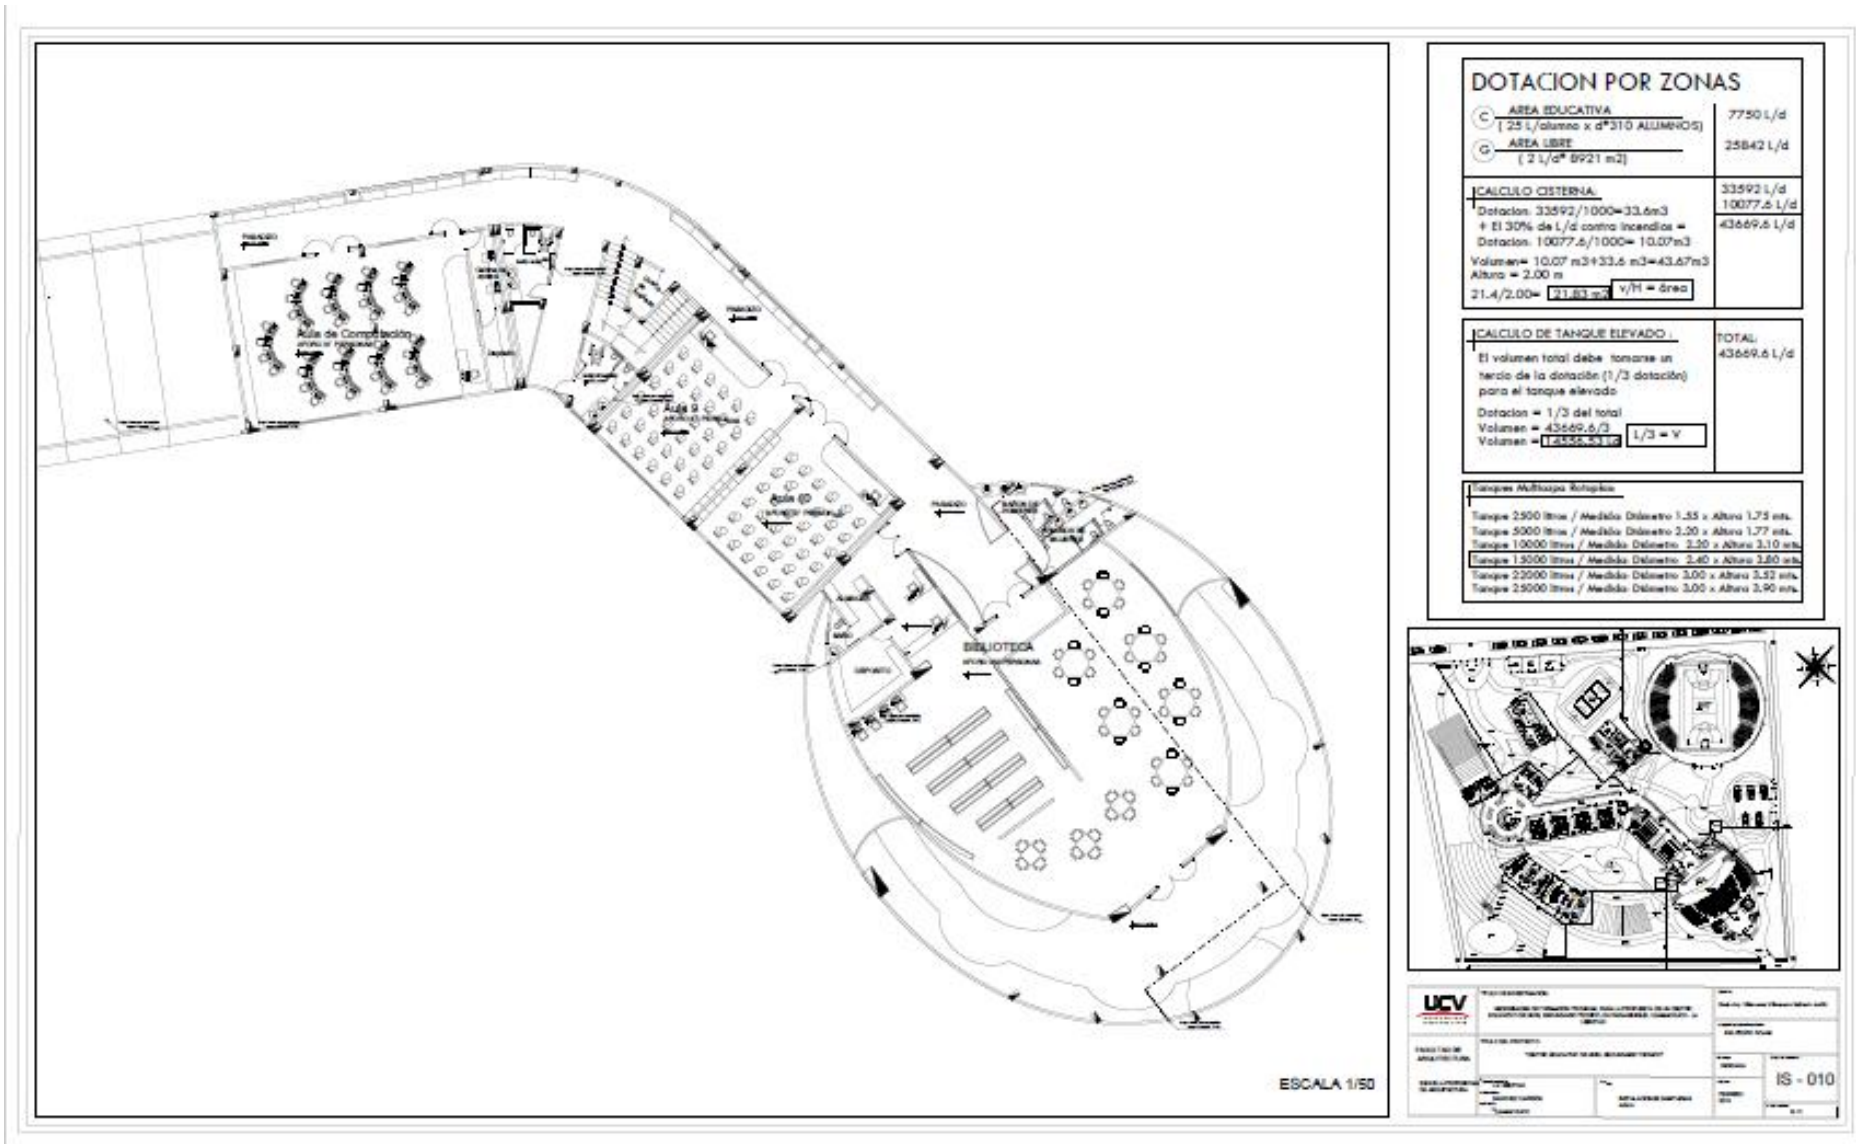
Plano de Diseño de Instalaciones Básicas Detalle – Agua - Plano N° 32 - Lamina IS-11
